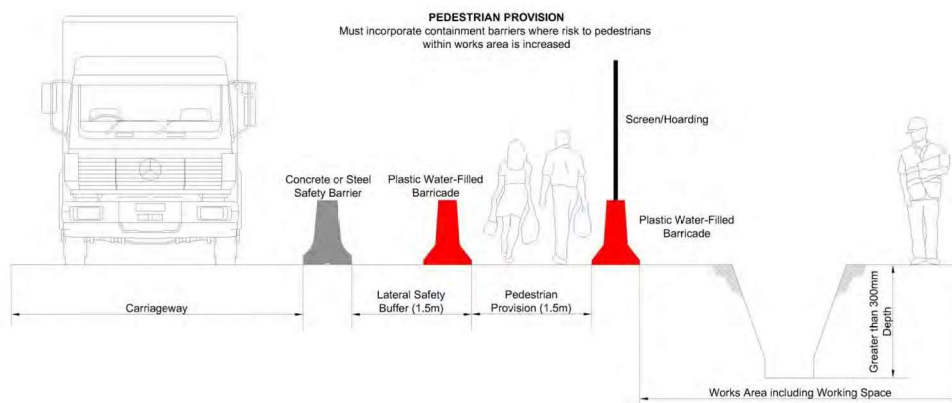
Voie piétonne dans la chaussée. Source : Work Zone Traffic Management Guidelines. Ashghal
